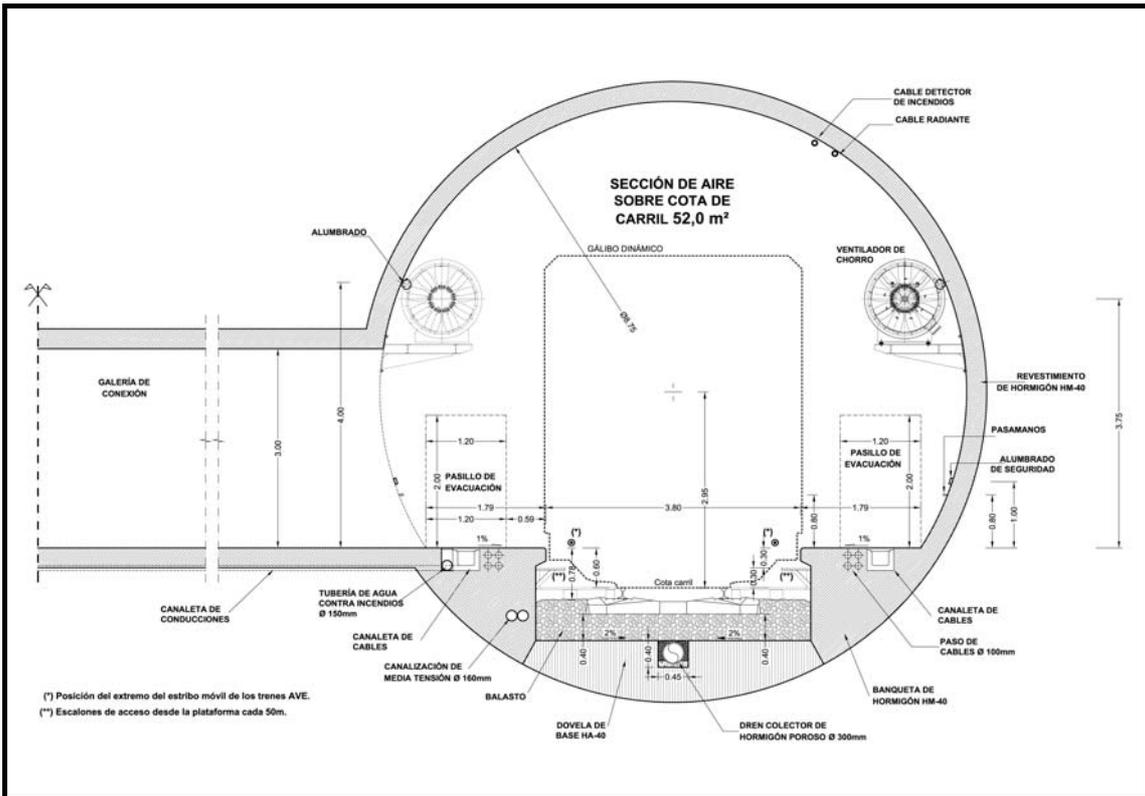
I.- Túnel de vía única con galerías de conexión
